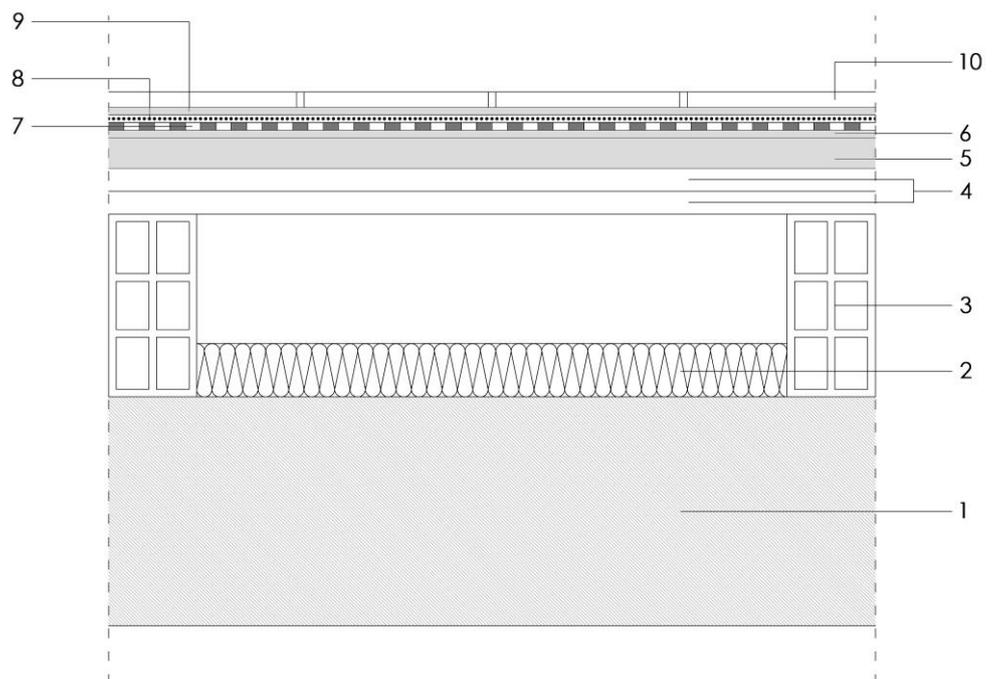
Detalle constructivo de cubierta mediterránea, fría o "catalana"
